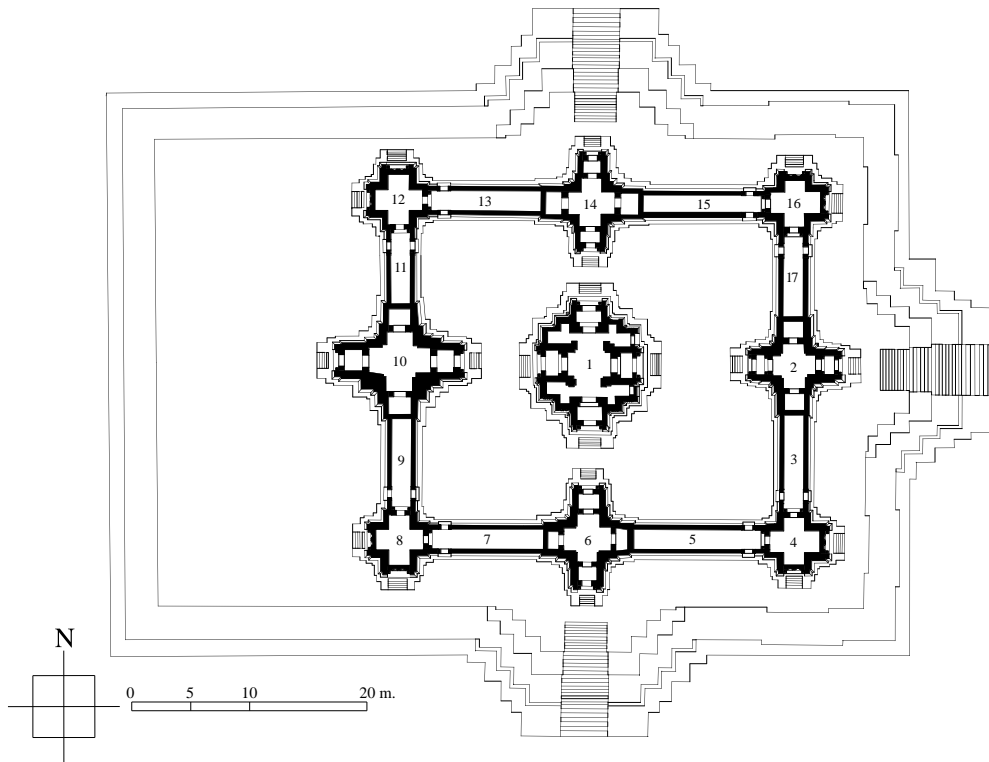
Vat Banon : plan d'ensemble (Fig. I-2-3-14 de l'annexe I, p. 48)
